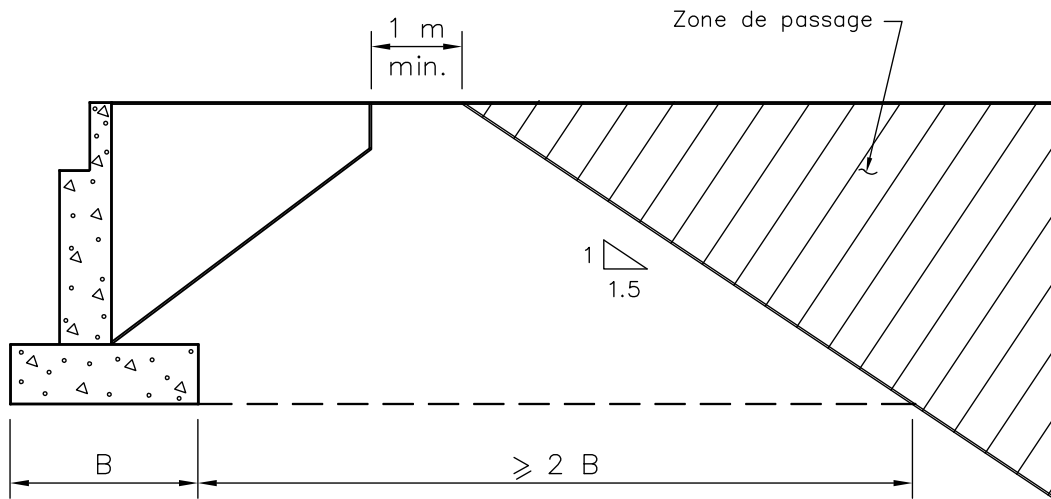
Zone de passage d'un conduit ou d'un groupe de conduits à l'arrière d'une culée
